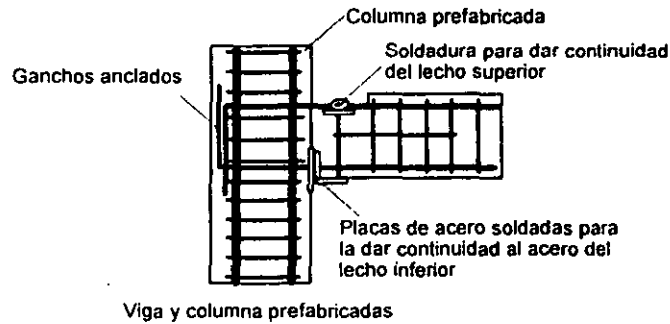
Conexiones viga-columna ensayadas en Canadá
